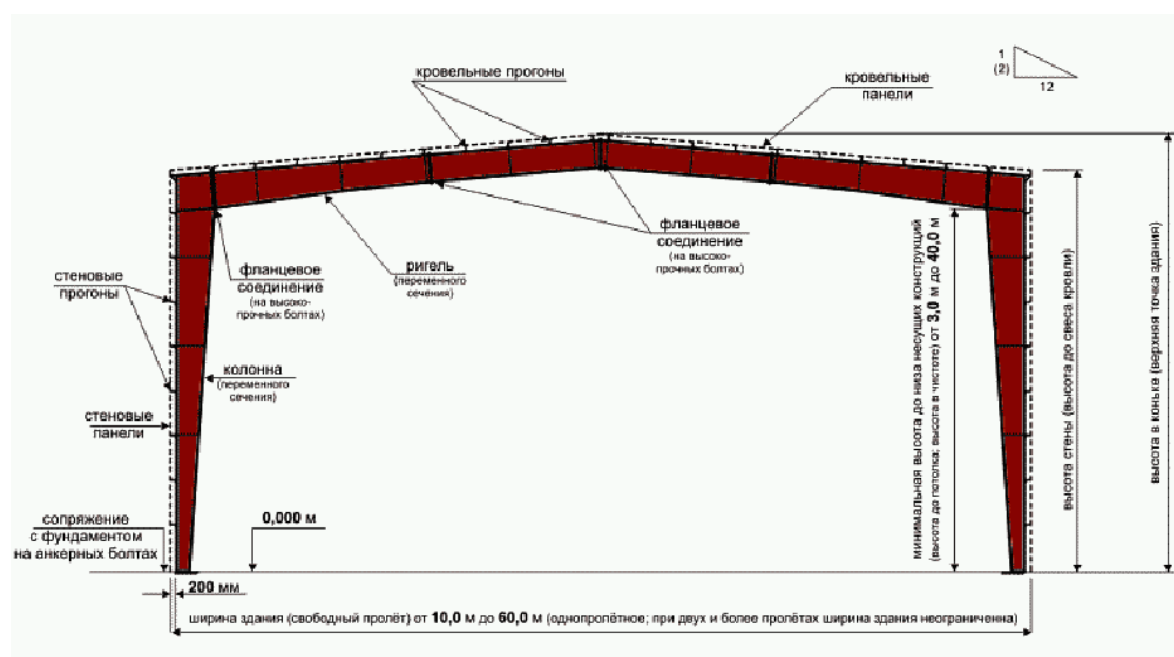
Вариант Несущей конструкции фирмы «Промет»
